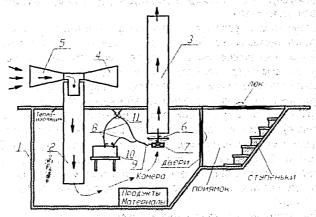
Холодильная камера в грунте без освещения (патент РБ №5073)
